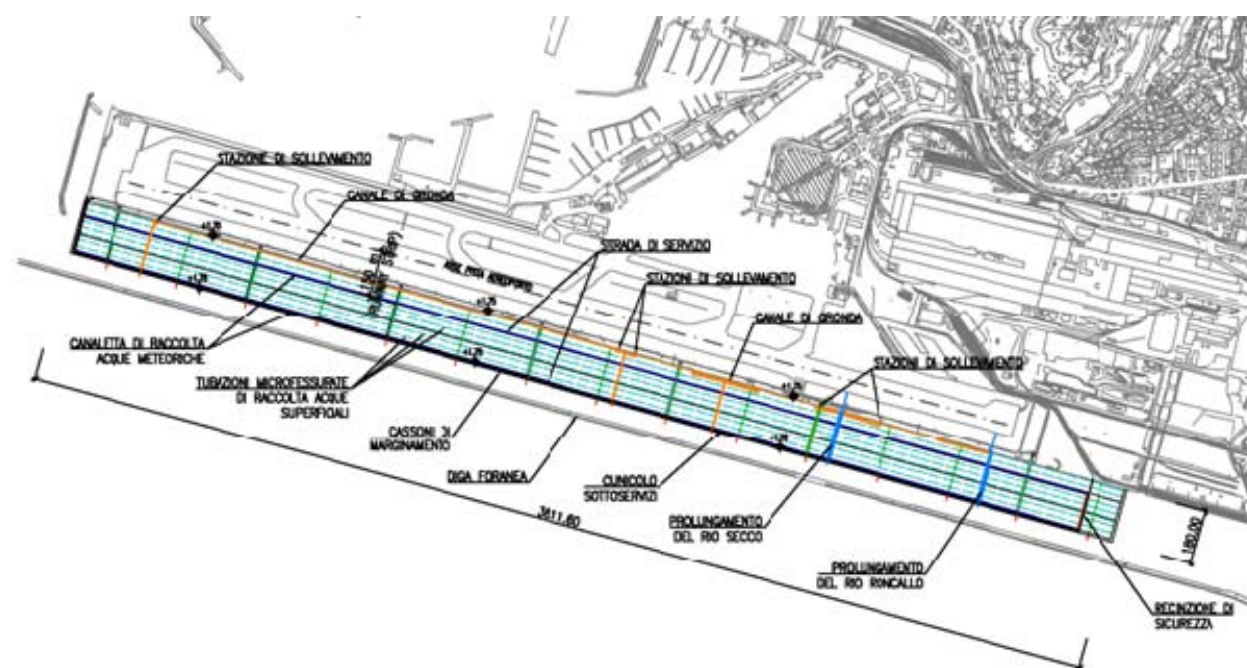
Opera a mare nel Canale di Calma - Layout finale della colmata - Planimetria
